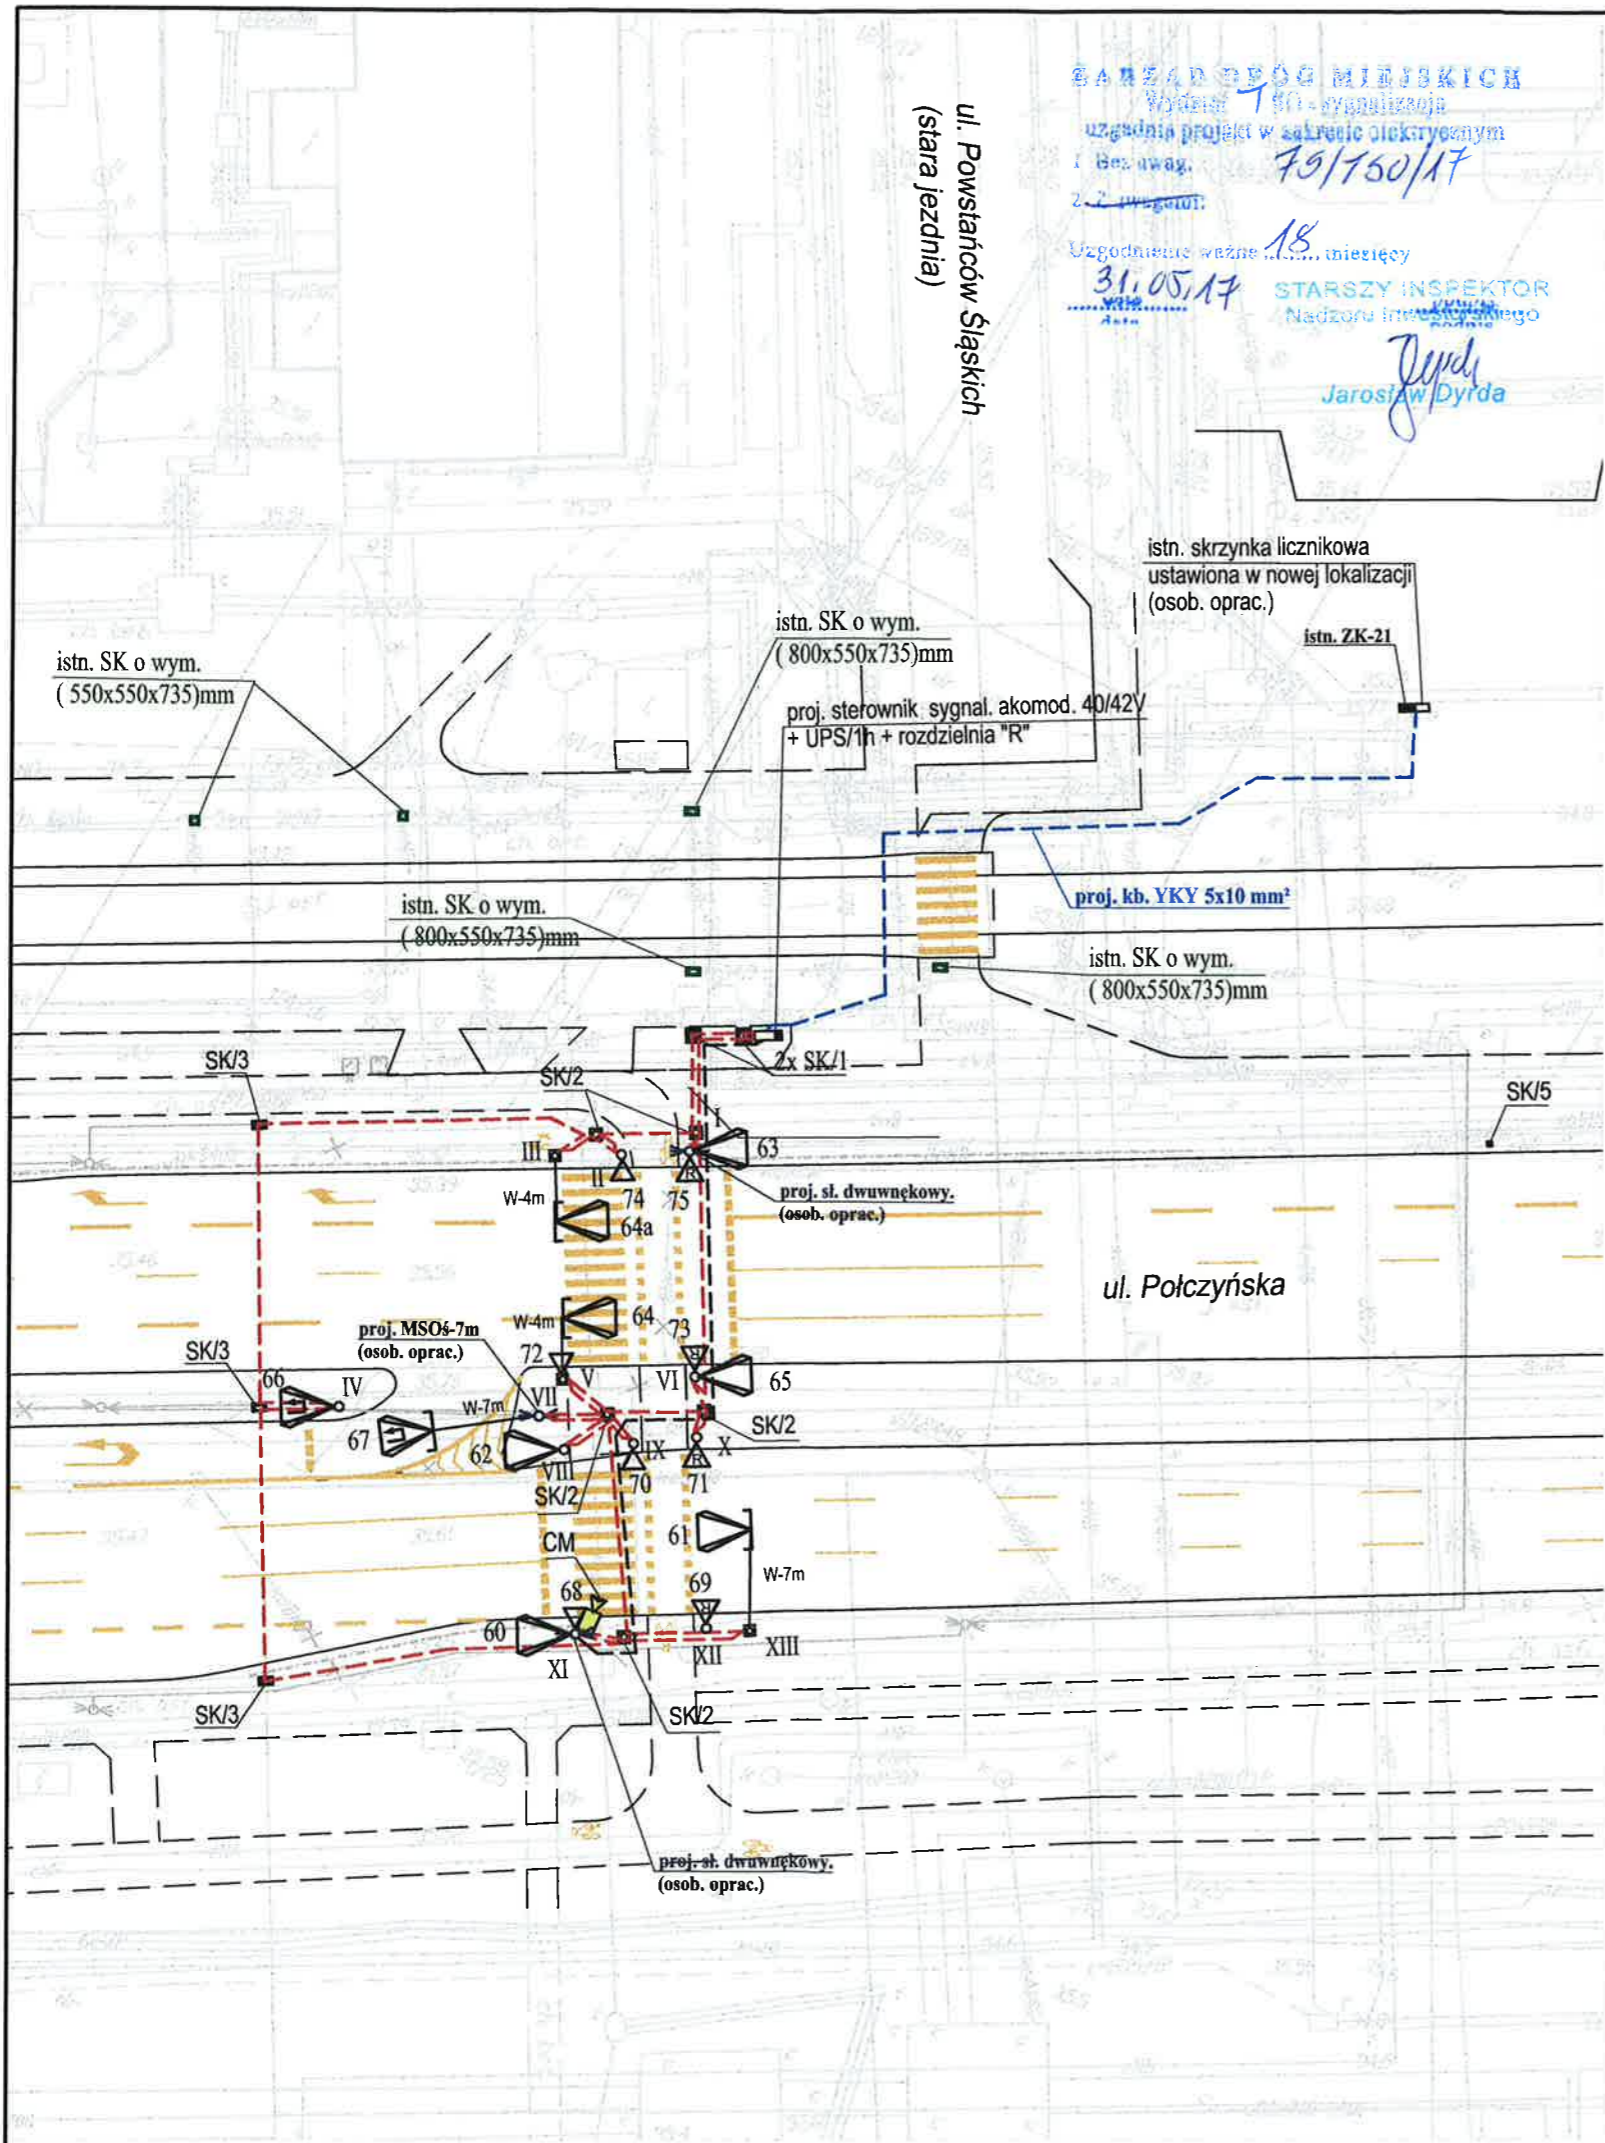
Plan automatycznej detekcji pieszej i rowerowej
